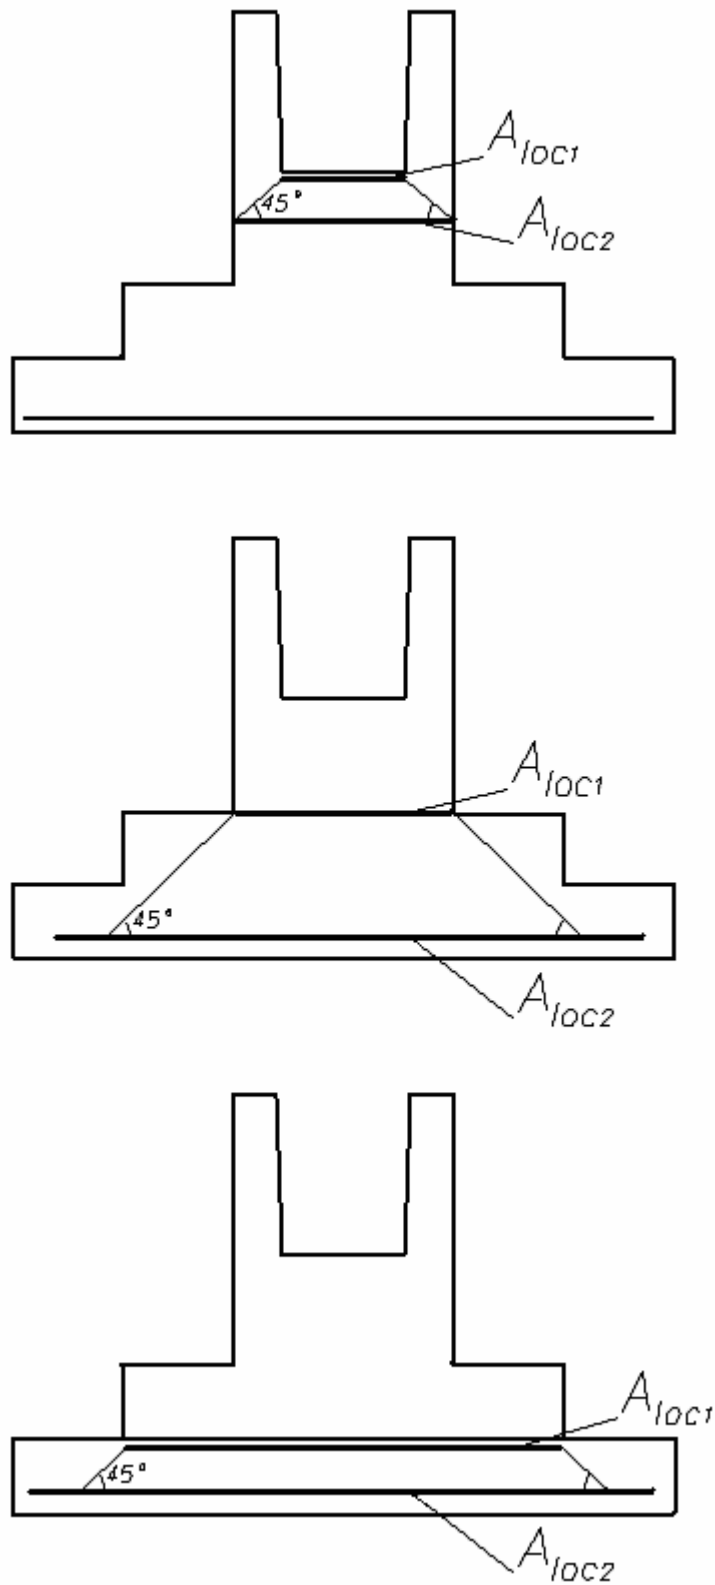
Схема для расчёта монолитных железобетонных фундаментов на местное сжатие: при расчёте подколонника и ступеней фундамента (A_{loc1} – площадь смятия, A_{loc2} – расчётная площадь).
